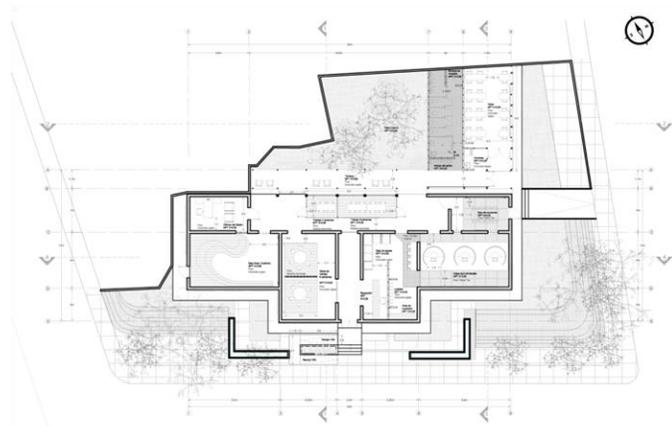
Planta arquitectónica del edificio patrimonial como sitio de trabajo colaborativo.
